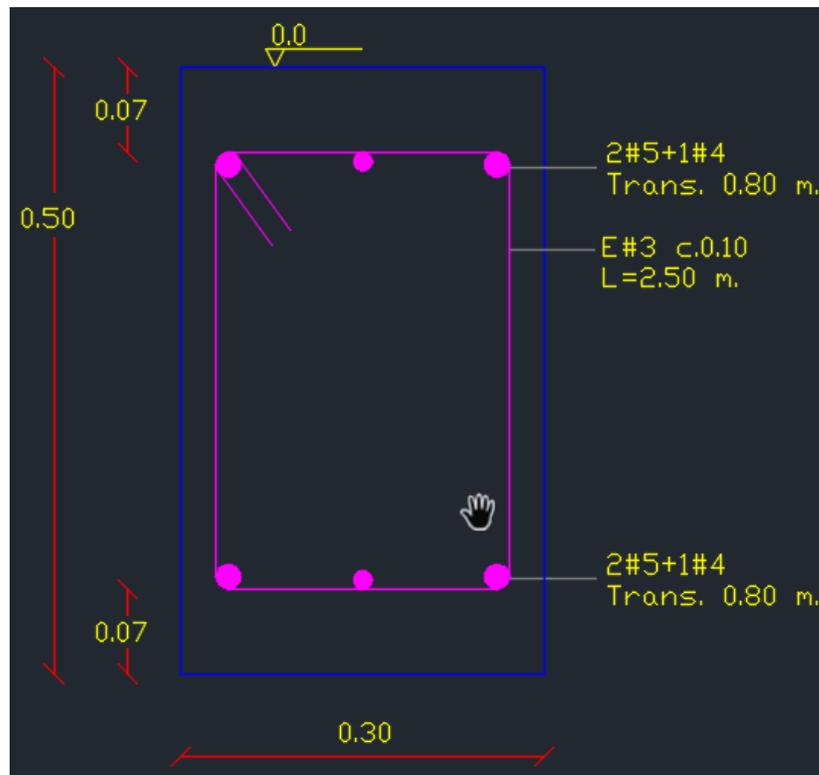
Viga de cimentación – Corte Z2-Z2
